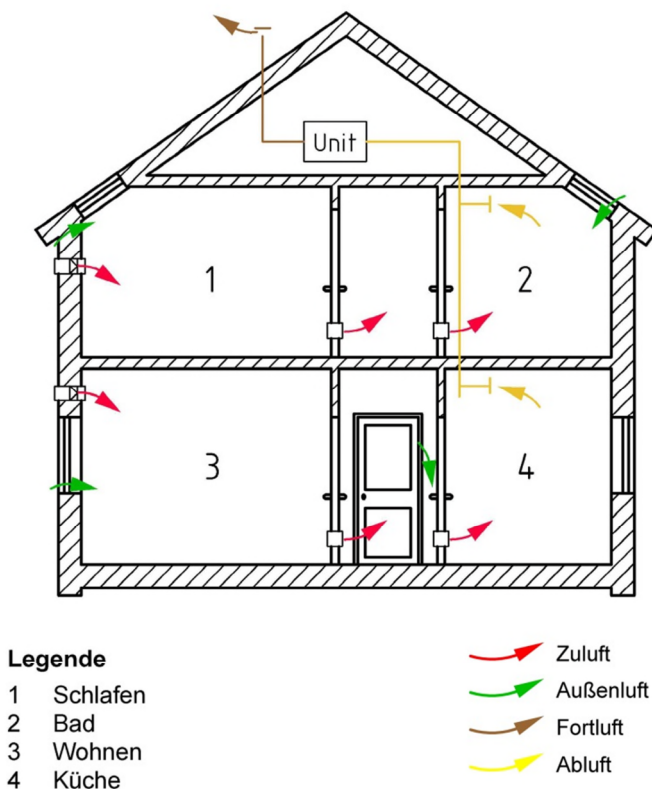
Bild A.5 - Abluftsystem, Zentralventilator-Lüftungsanlage mit ALD im EFH; [2]
